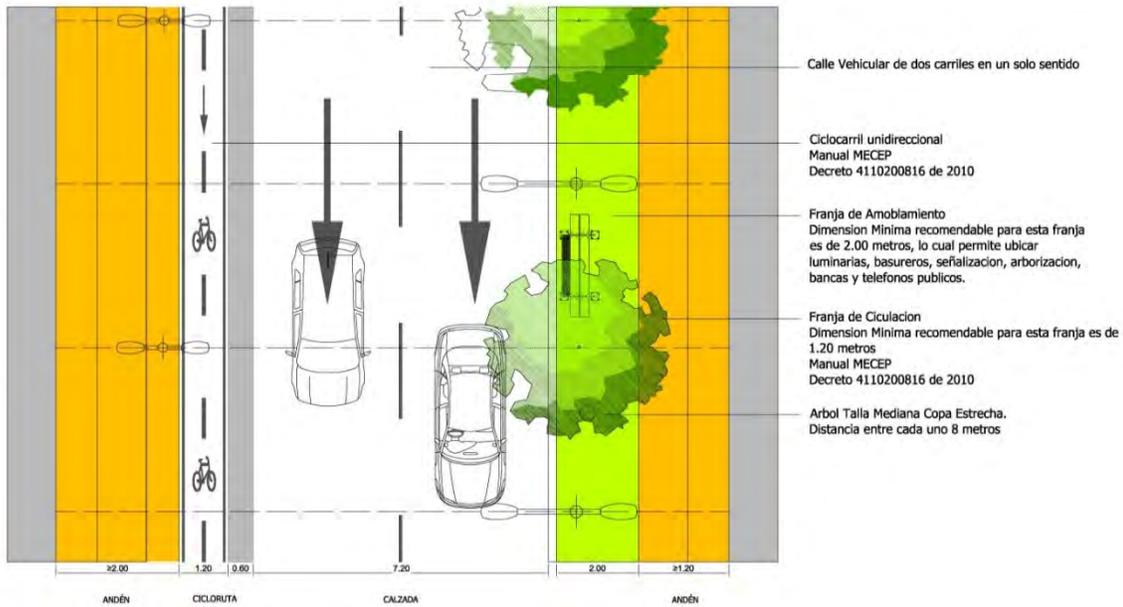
Sección Transversal de Calle 10 entre carreras 10 y 5
